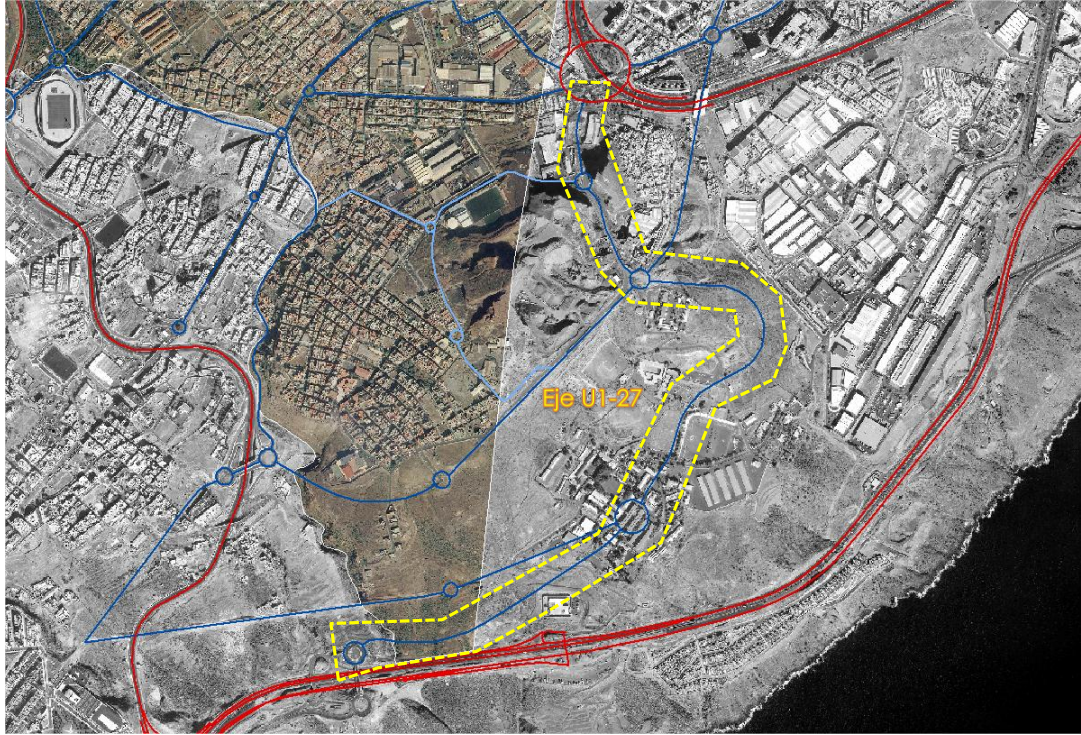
Eje U1-27: Hoya Fría – Autopista TF-1
